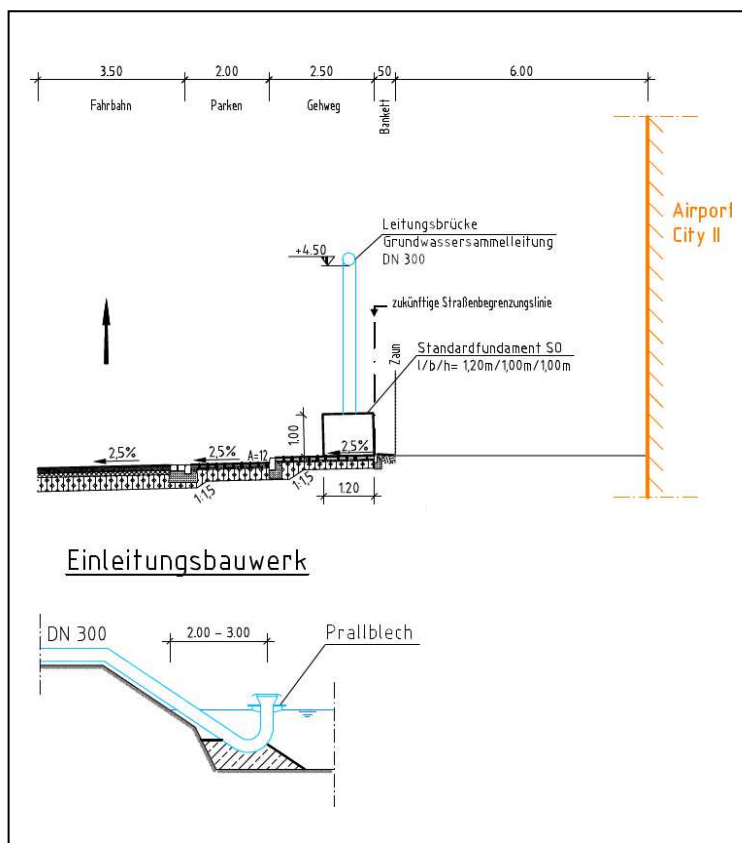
Systemschnitt Leitungsbrücke / Grundwassersammelleitung, Einleitungsbauwerk Kittelbach (Quelle: VÖSSING, 2014)
